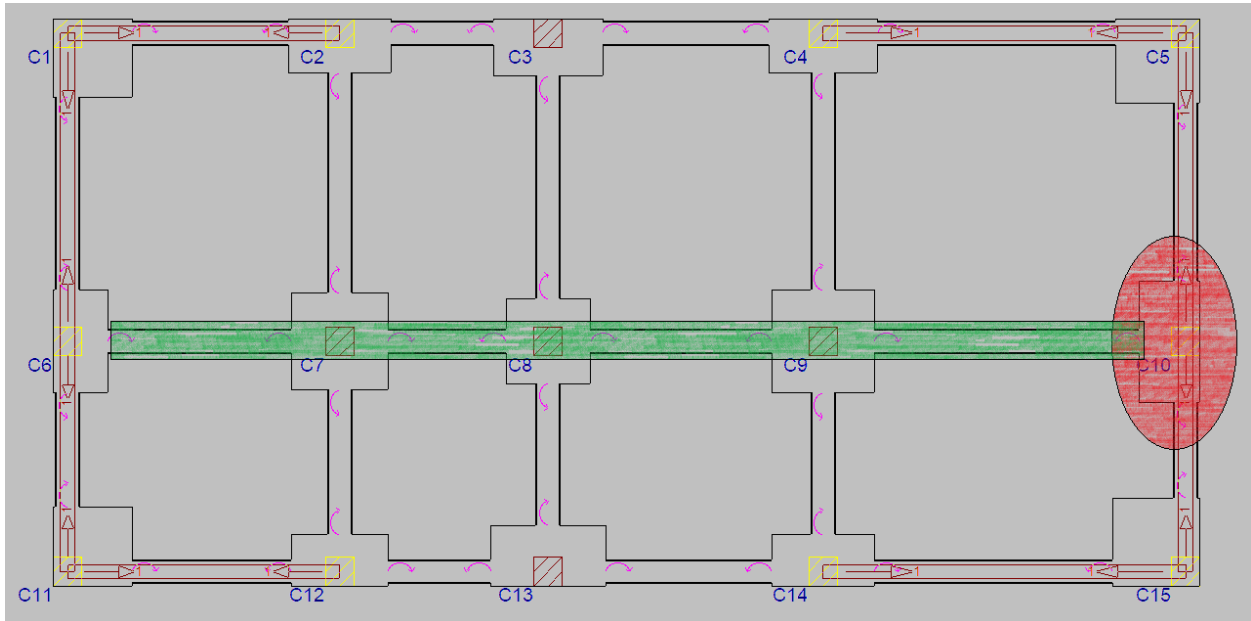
Losa aligerada con viguetas metálicas nivel 4
